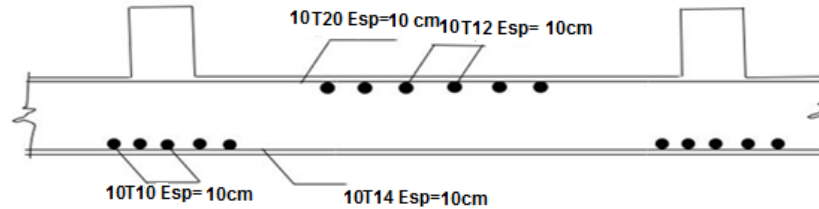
Schéma de ferrailage de la dalle du radier
